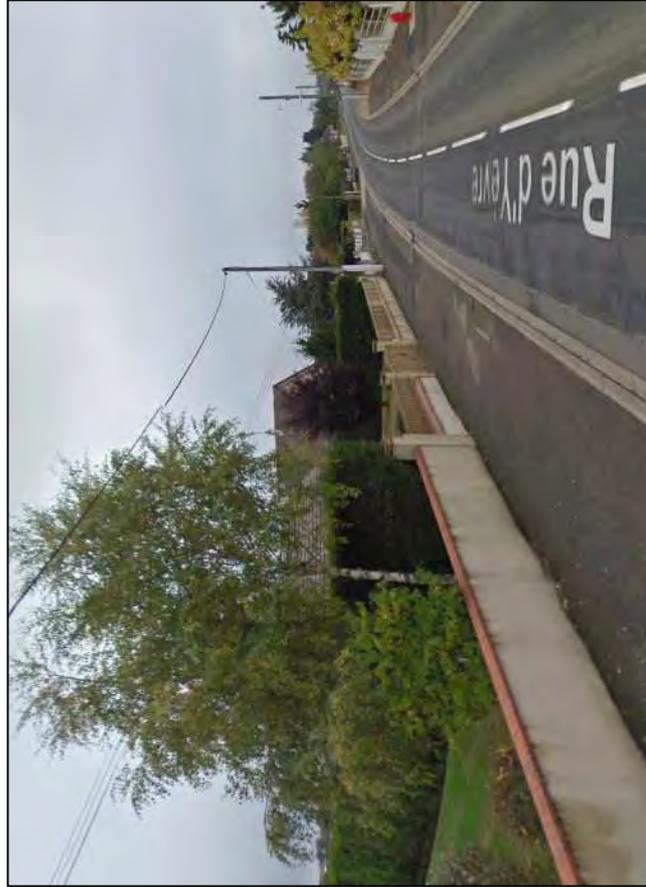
Photographie de l'emprise nécessaire à l'aménagement du réseau viaire situé à proximité du projet de collège (chicanes et écluses) - Google Street View
